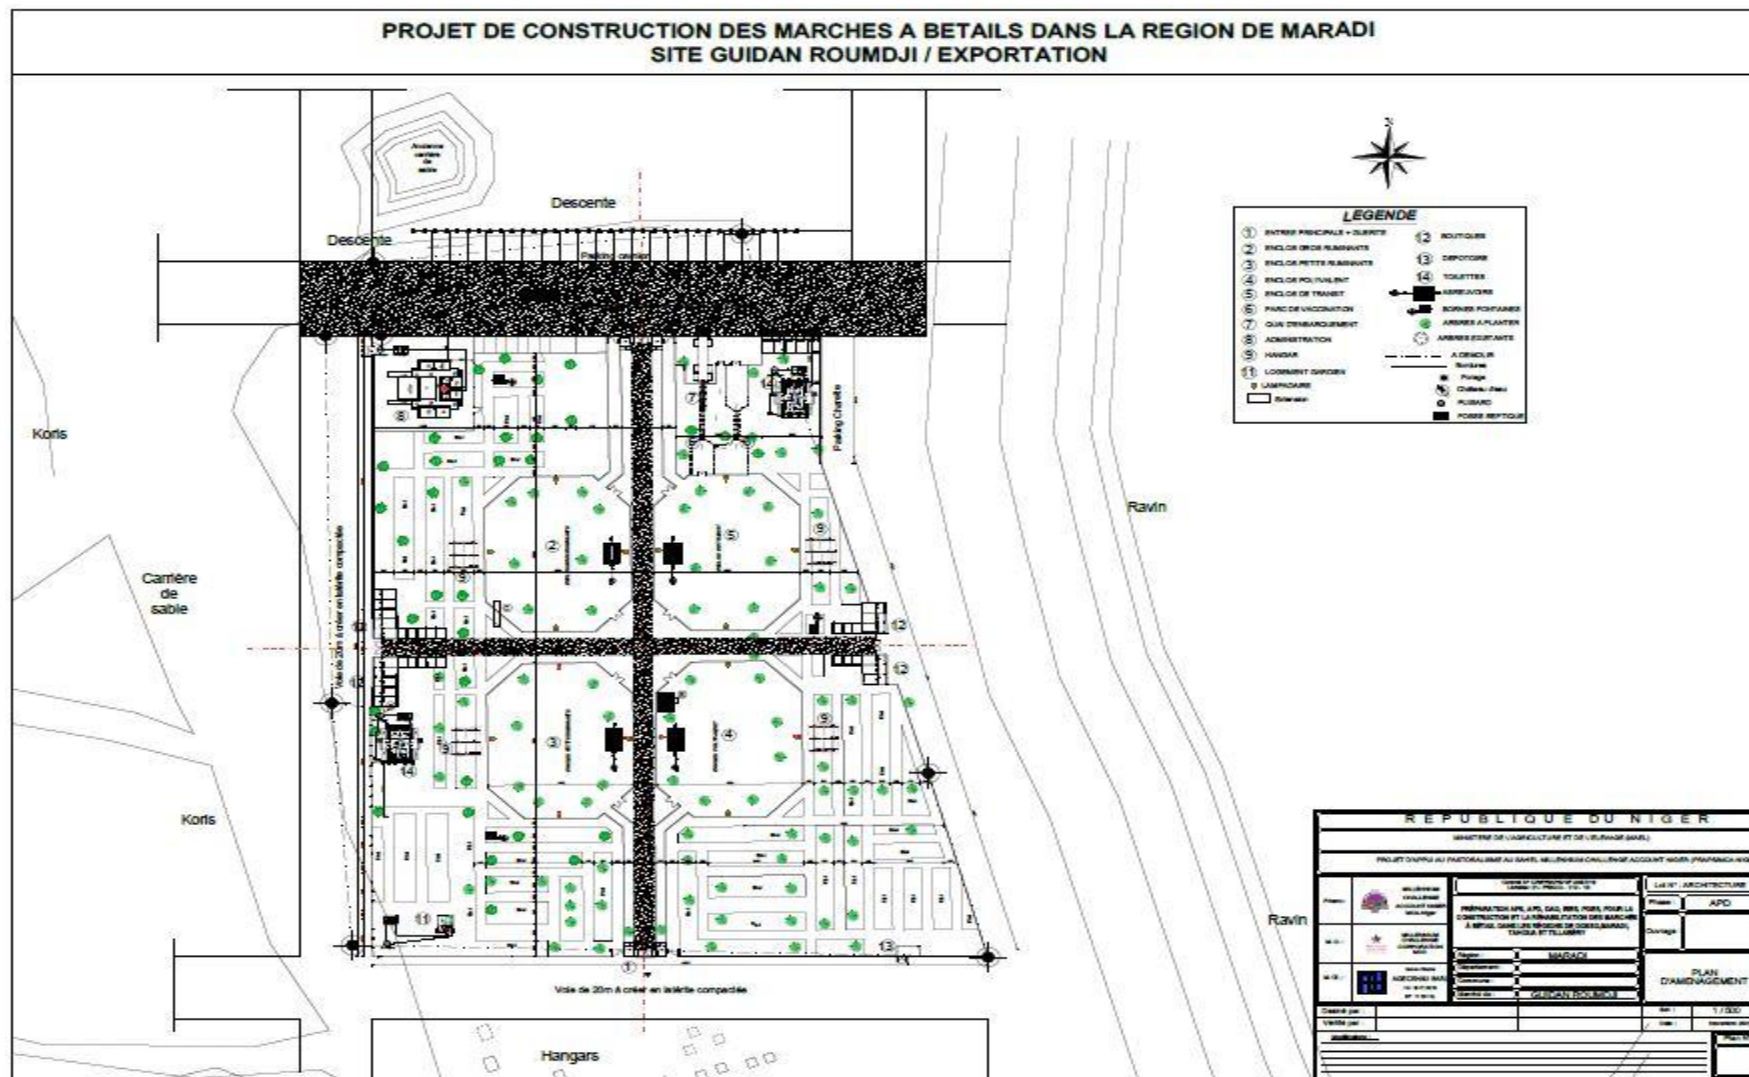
Plan de masse et d'aménagement du marché de Guidan Roudji
